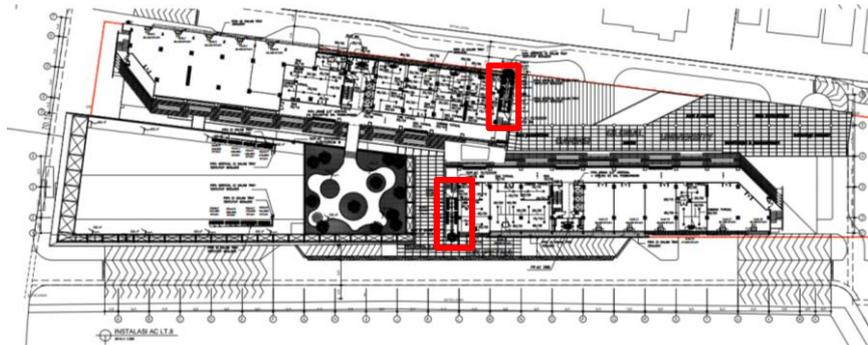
Denah posisi outdoor vrv pada lantai 2
